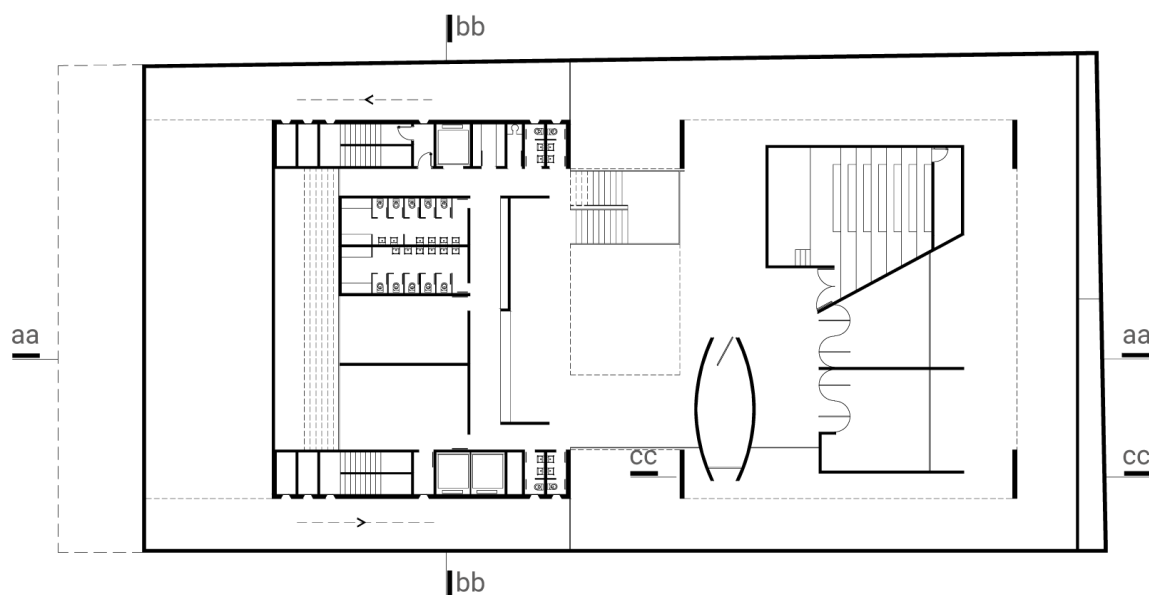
Sede para a SBPC (1978, 1º lugar): redesenho da planta térreo inferior. Fonte: autores.
